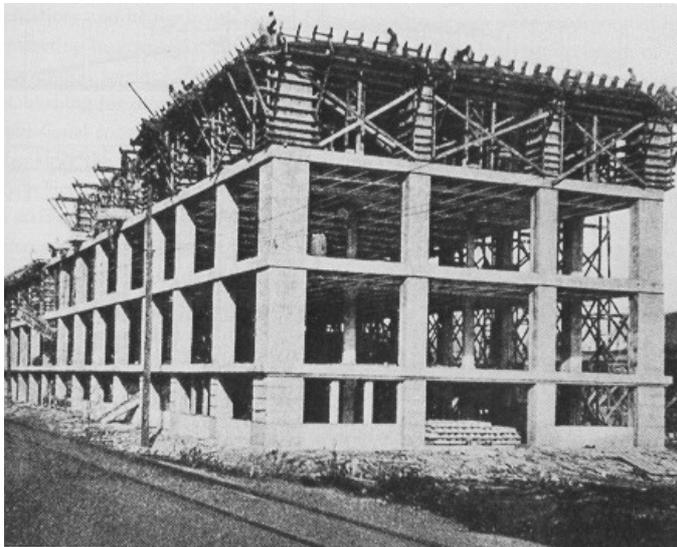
Casa de máquinas com quatro pavimentos construída por Ransome em 1901 em Greensburg, Pennsylvania. Pisos e deixam espaço para grandes janelas.
